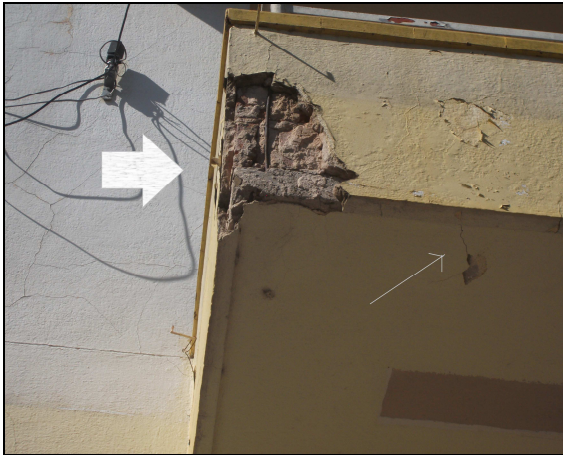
Fissuras na alvenaria, sacada S8
